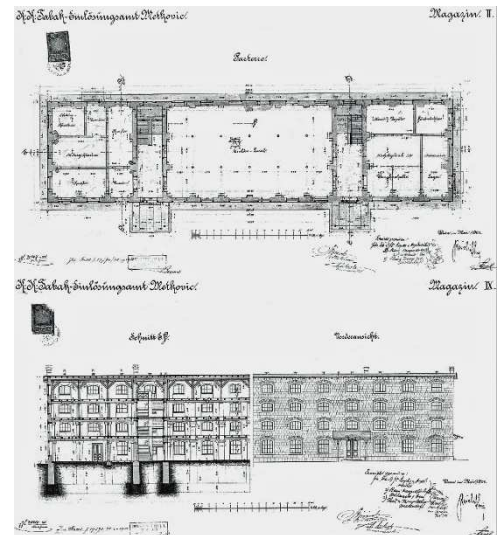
Grundriss, Erdgeschoss, Lager. in Metković, Schnitt und Fassade, 1901.
